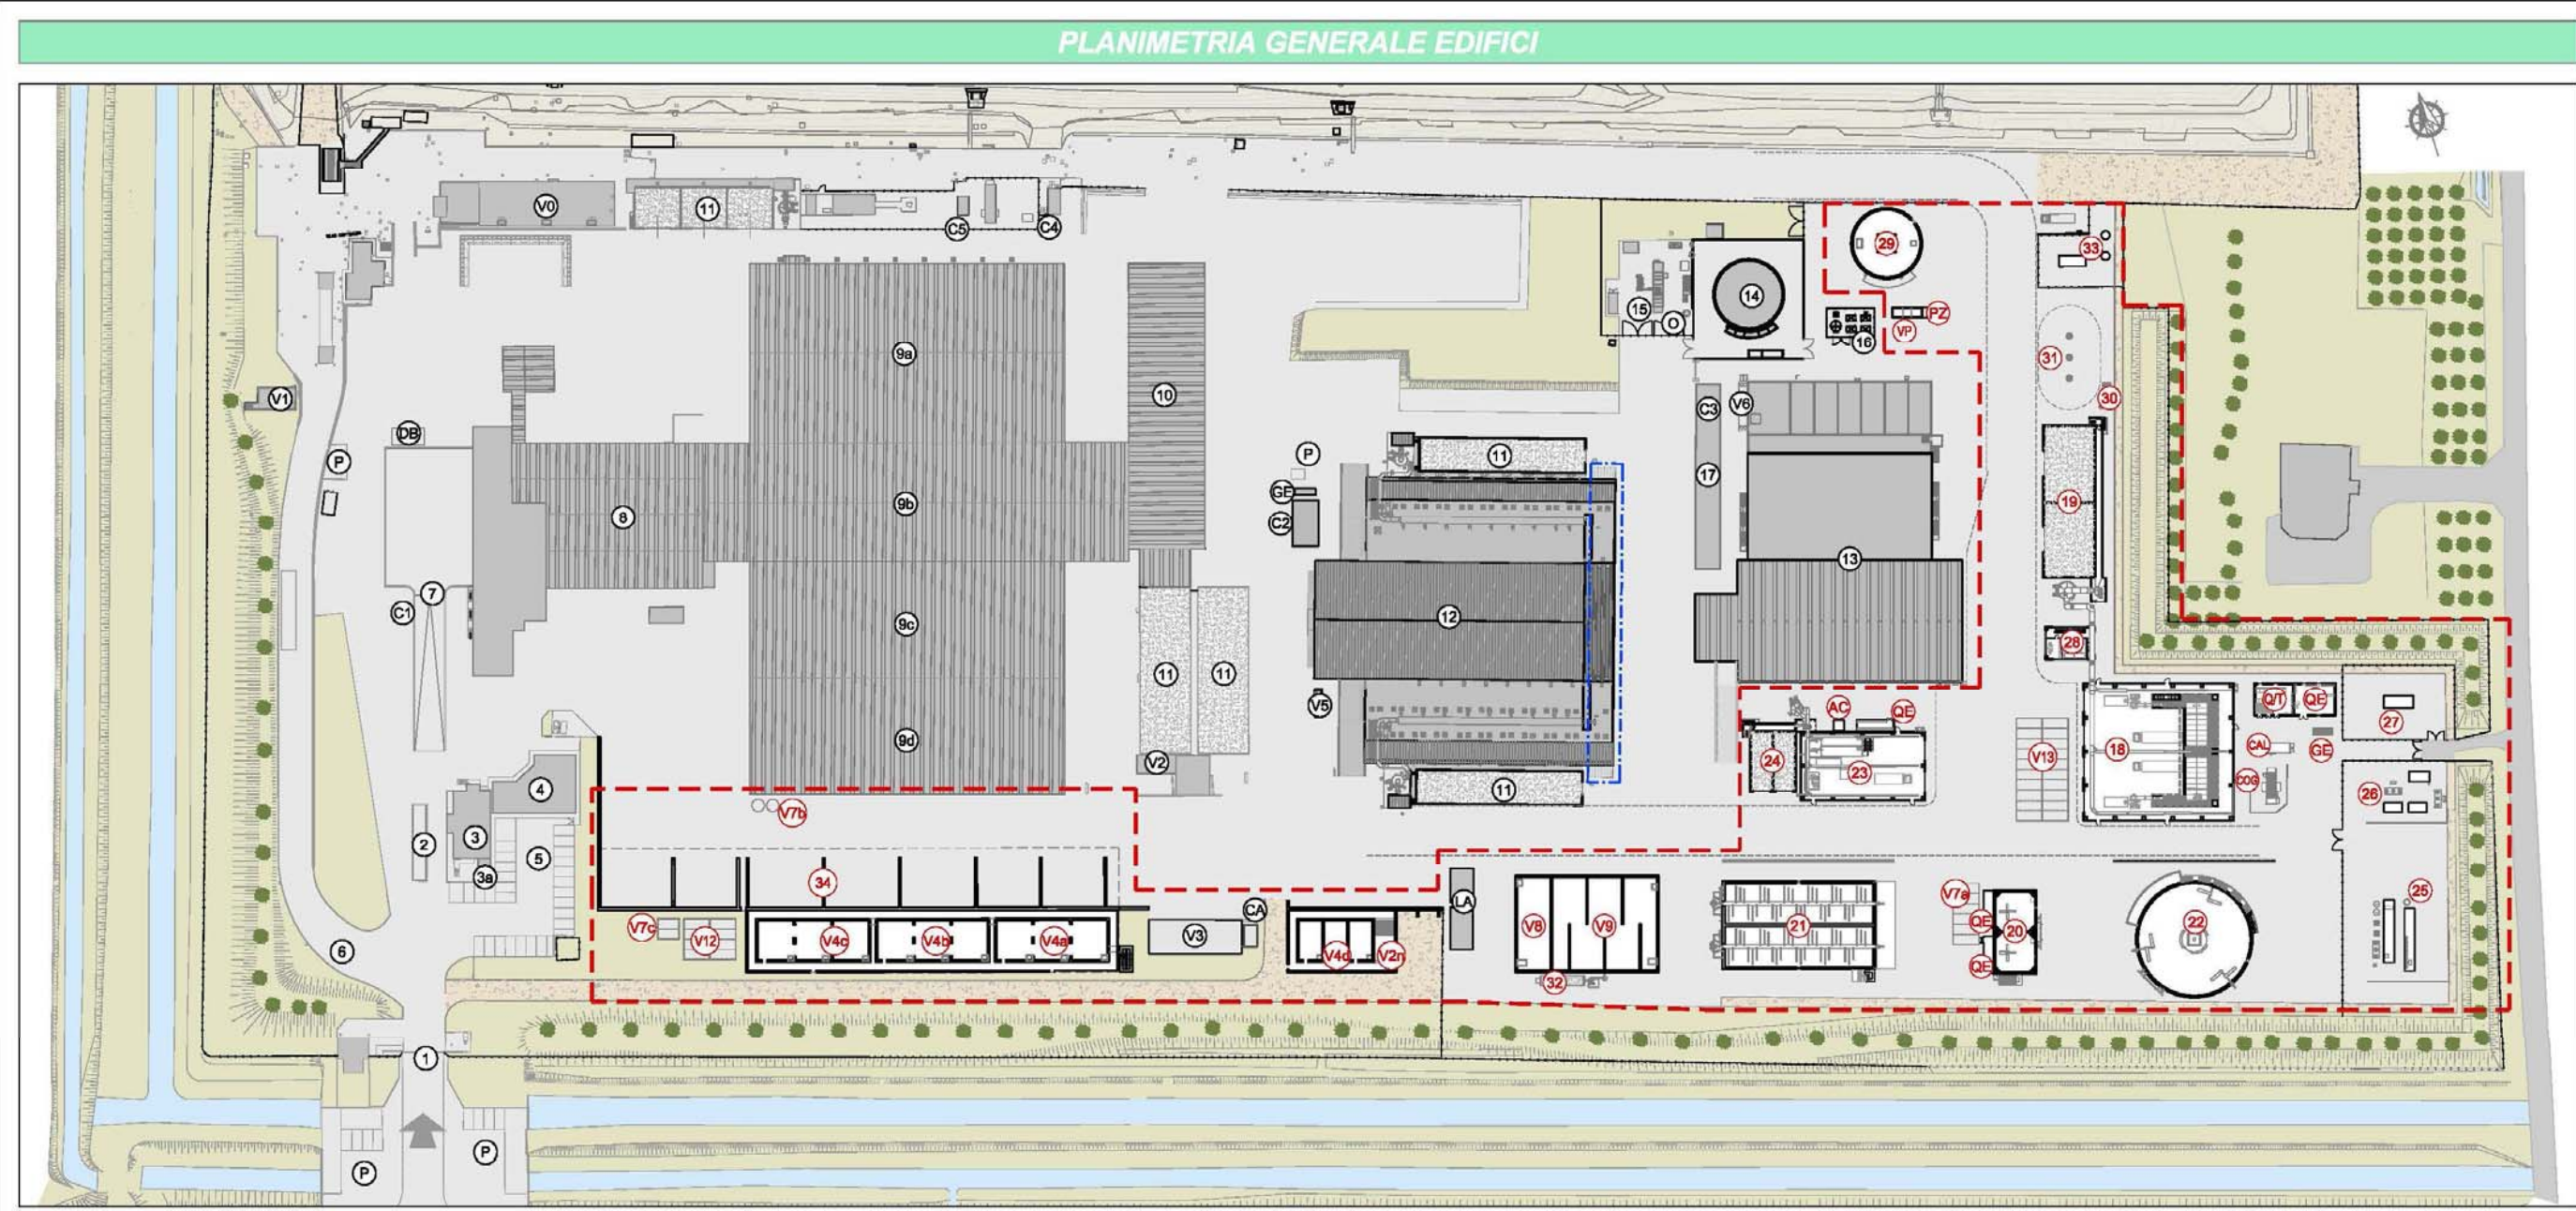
Estratto tavola ARC_002 - Planimetria con indicazione delle principali sezioni impiantistiche di progetto
